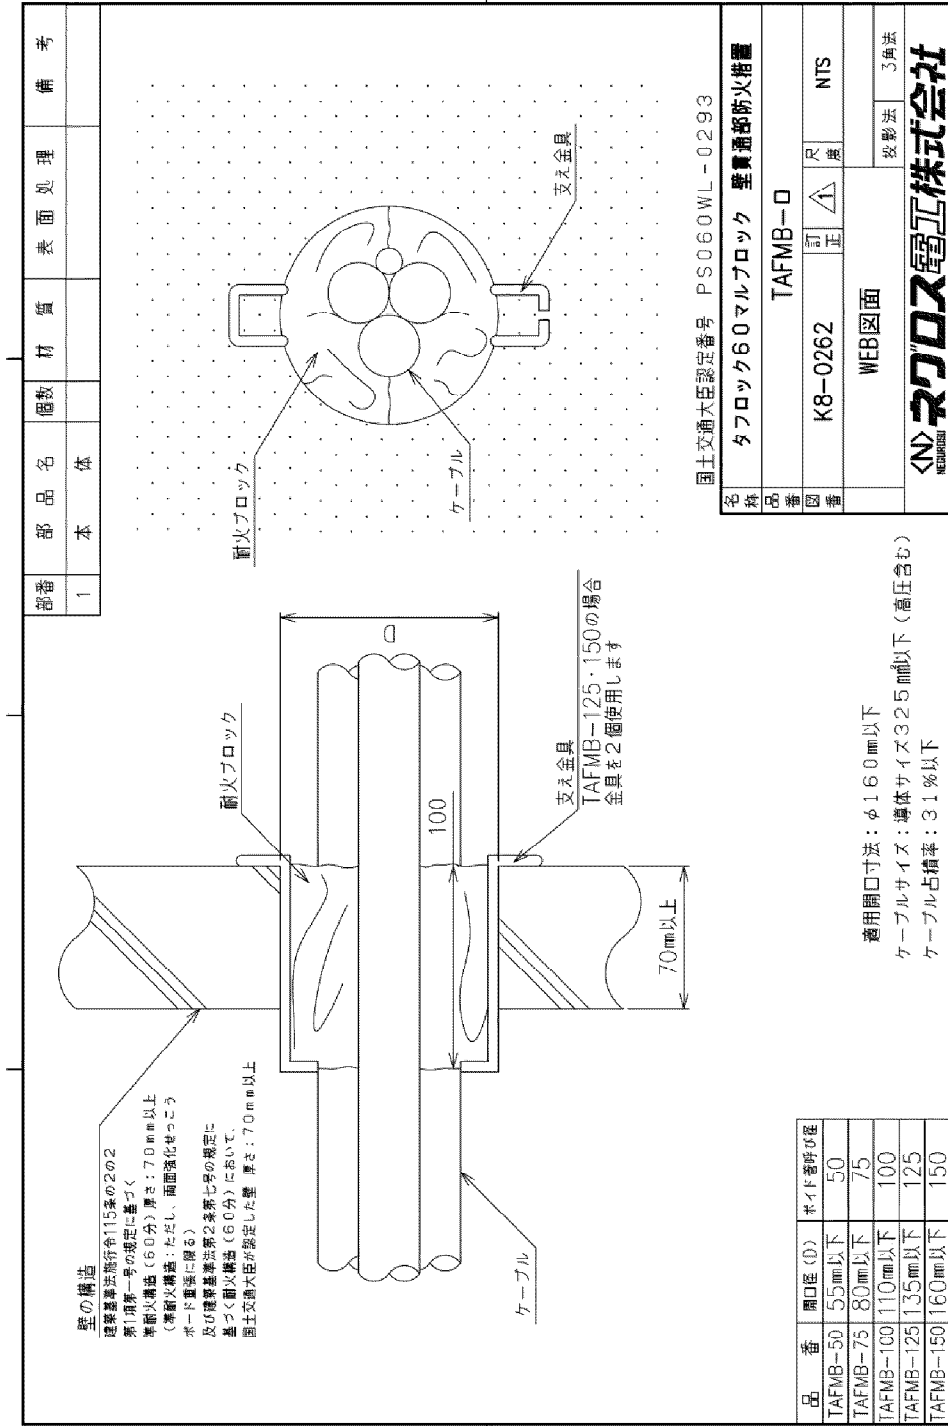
鉄筋コンクリート・軽量気泡コンクリート(ALC)壁 標準施工図
